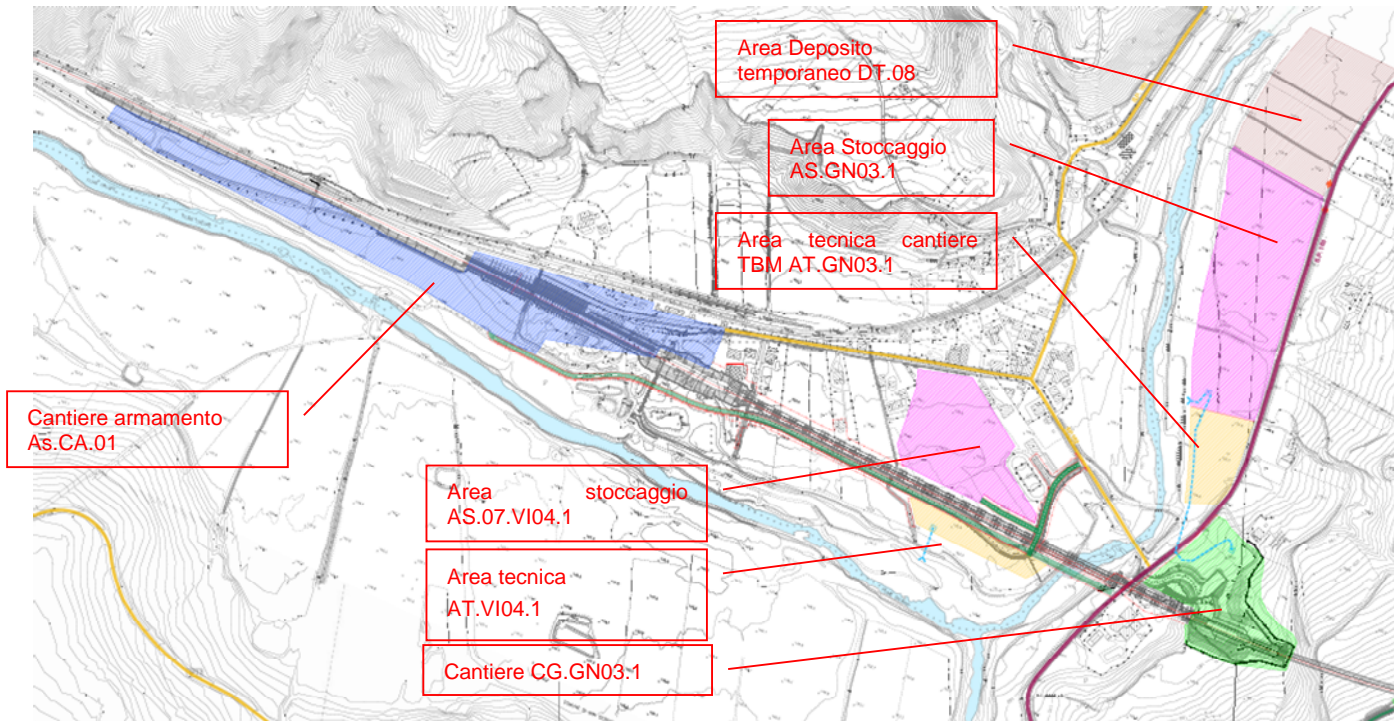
Area Rocchetta: inquadramento generale sistema di cantierizzazione
